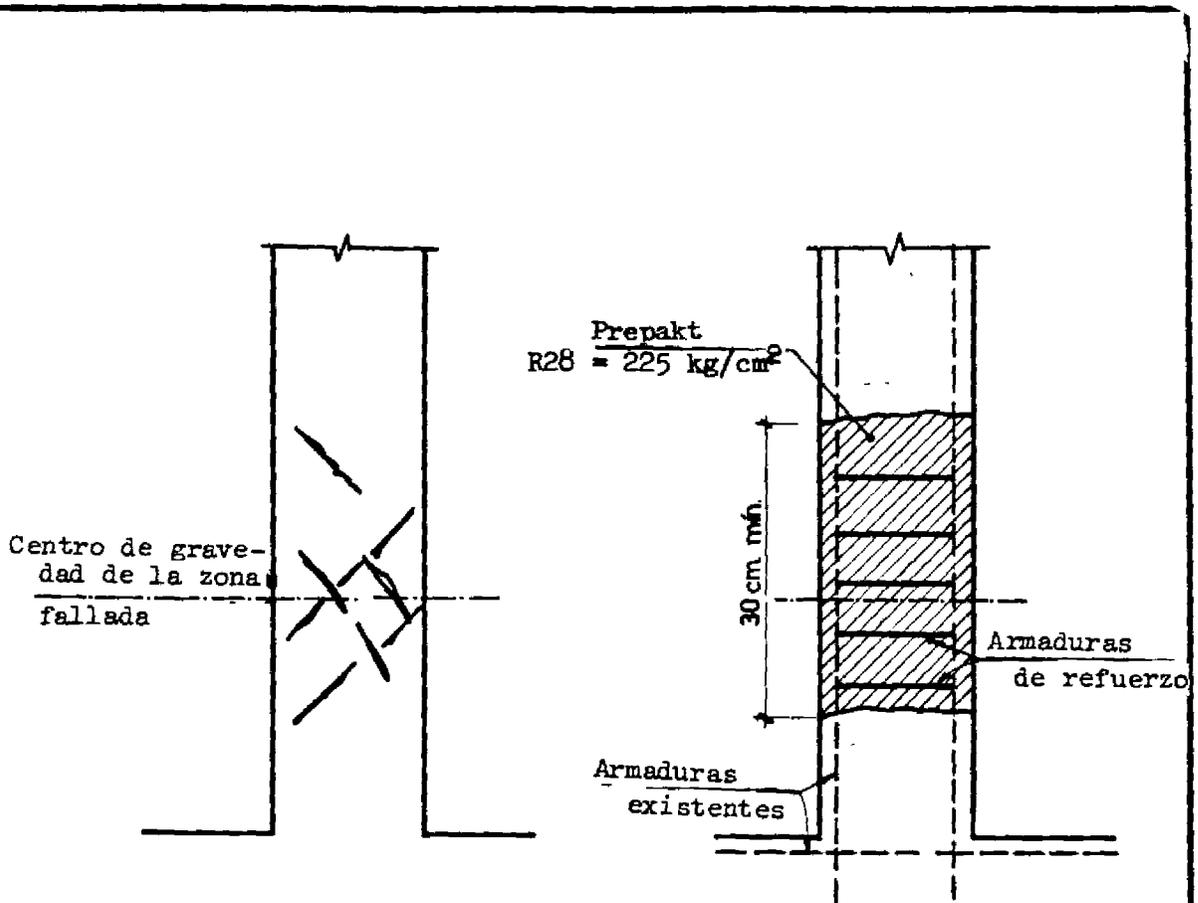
Caso P-1. REFUERZO DE UN PILAR DE HORMIGON ARMADO CON HORMIGON INYECTADO
